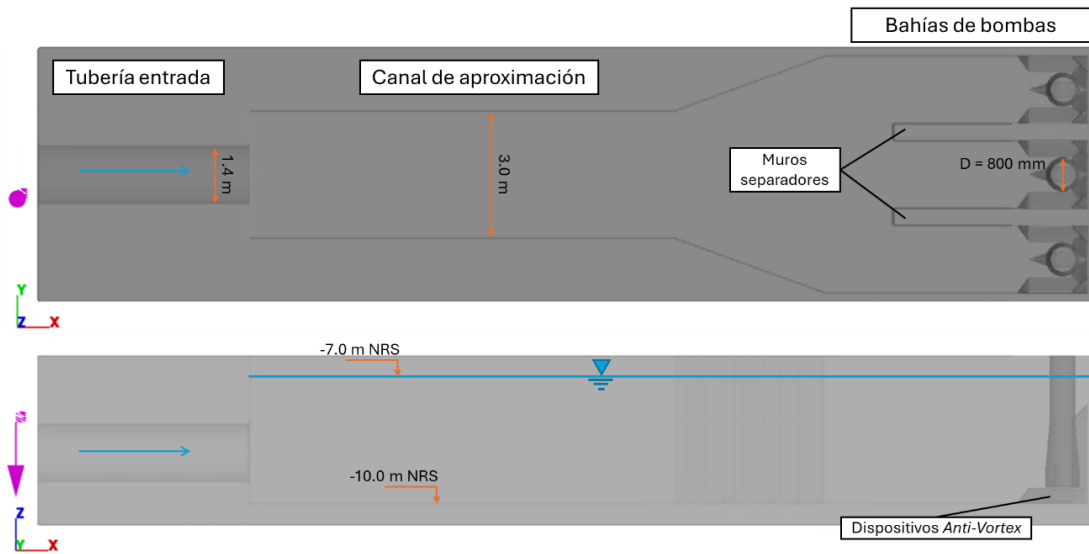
Vista de la geometría del caso de estudio en planta (panel superior) y elevación (panel inferior).
